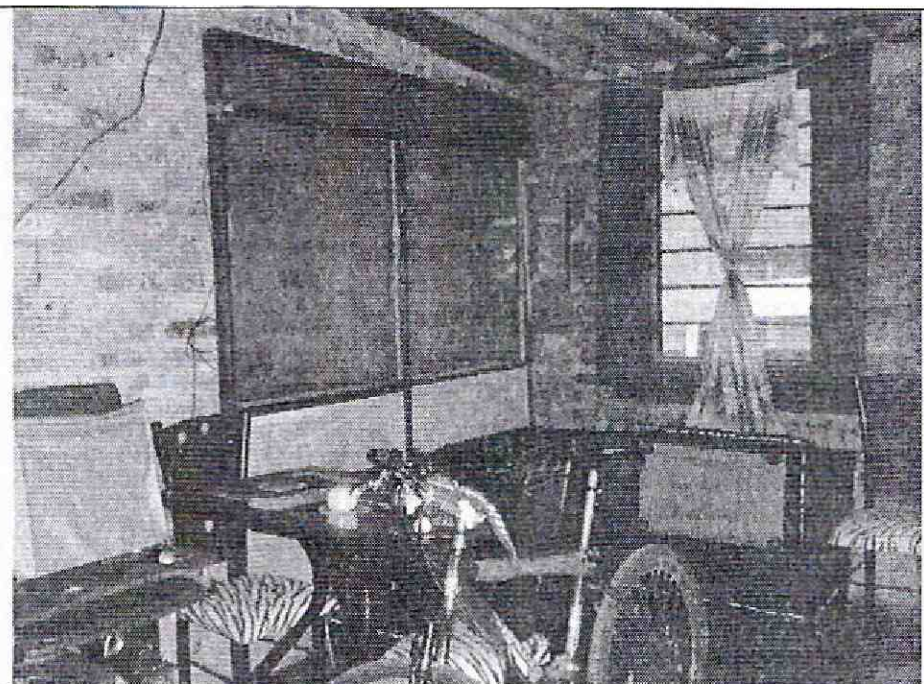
Vista interior sector sala comedor localizado en el costado norte sobre la fachada principal. No se observa daños.
